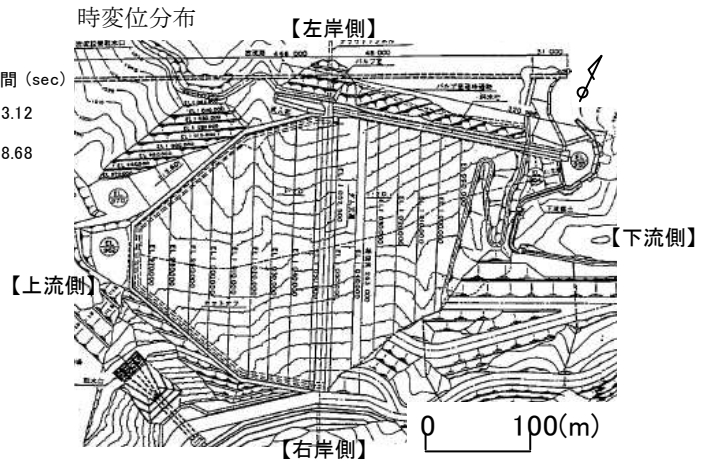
八汐ダム平面図（基礎掘削形状）
